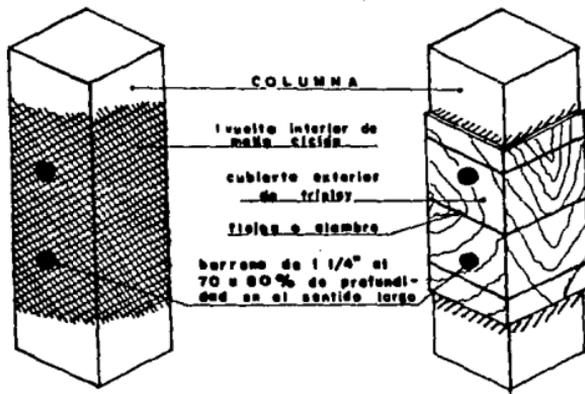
Barrenado y protección en columnas de concreto.
